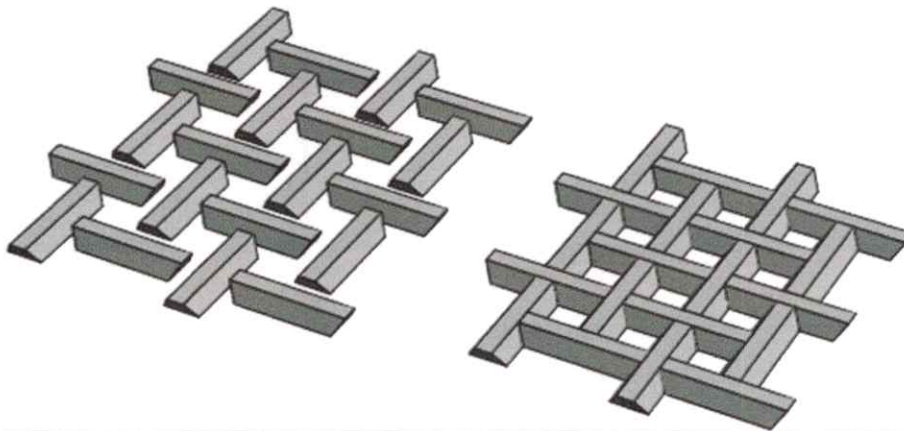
Éclaté et entièrement assemblé des vues 3D de l'ensemble plat en pierre inspirée de celle proposée par Joseph Abeille in1699, source : Journal of Space Structures
